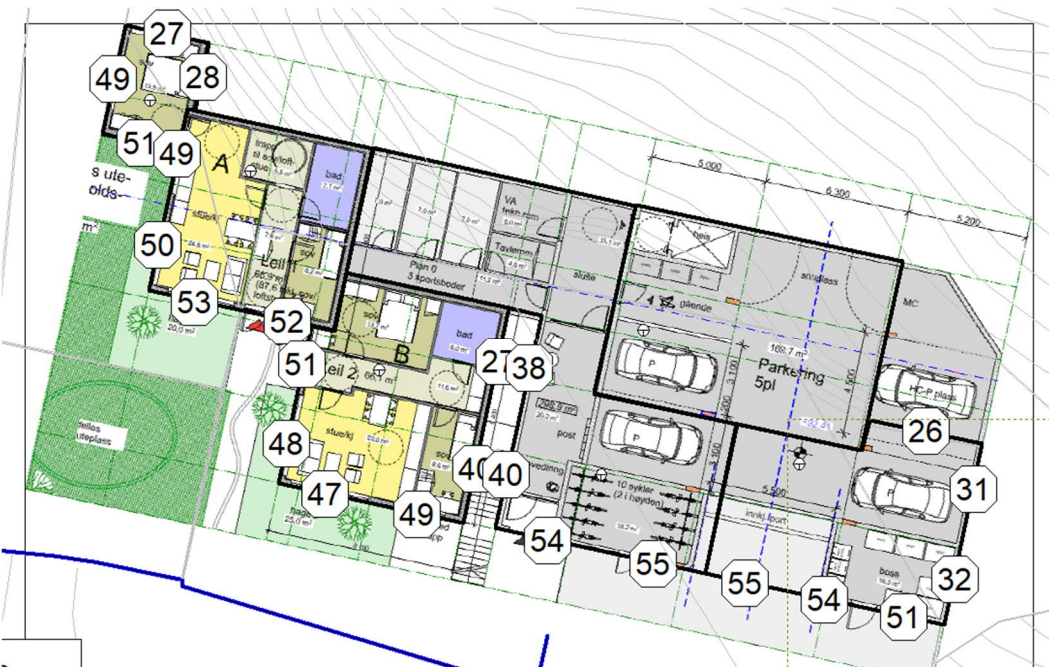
Støynivå, L_{den} , 1,5 m over bakkeplan, skjermet.
